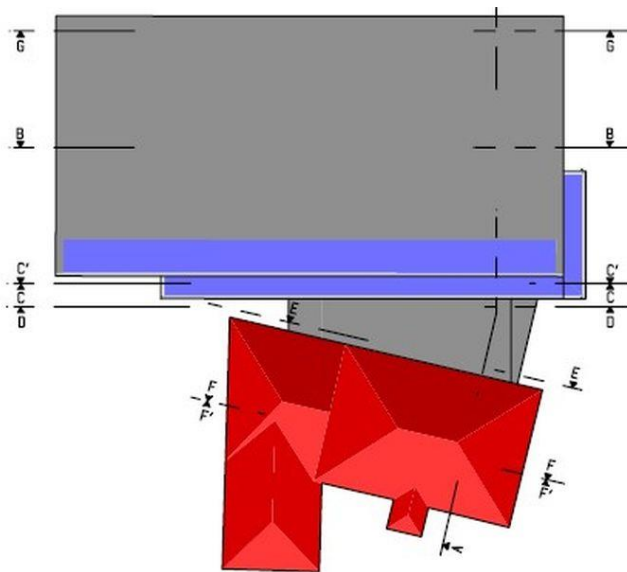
Gebäudeschema, Altbau rot dargestellt (© Plan: Stadt Dohna)
